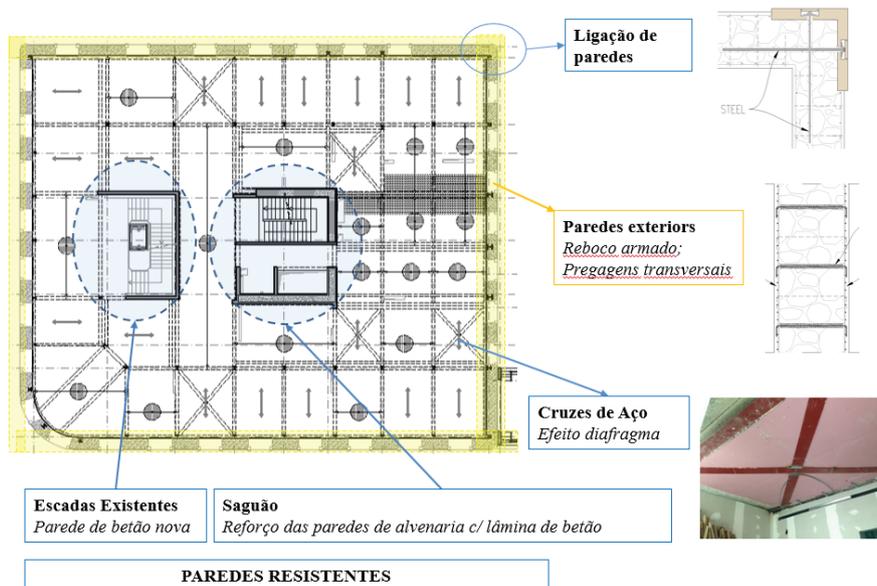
Solução estrutural de reforço no Bloco A (Reforço Sísmico)
